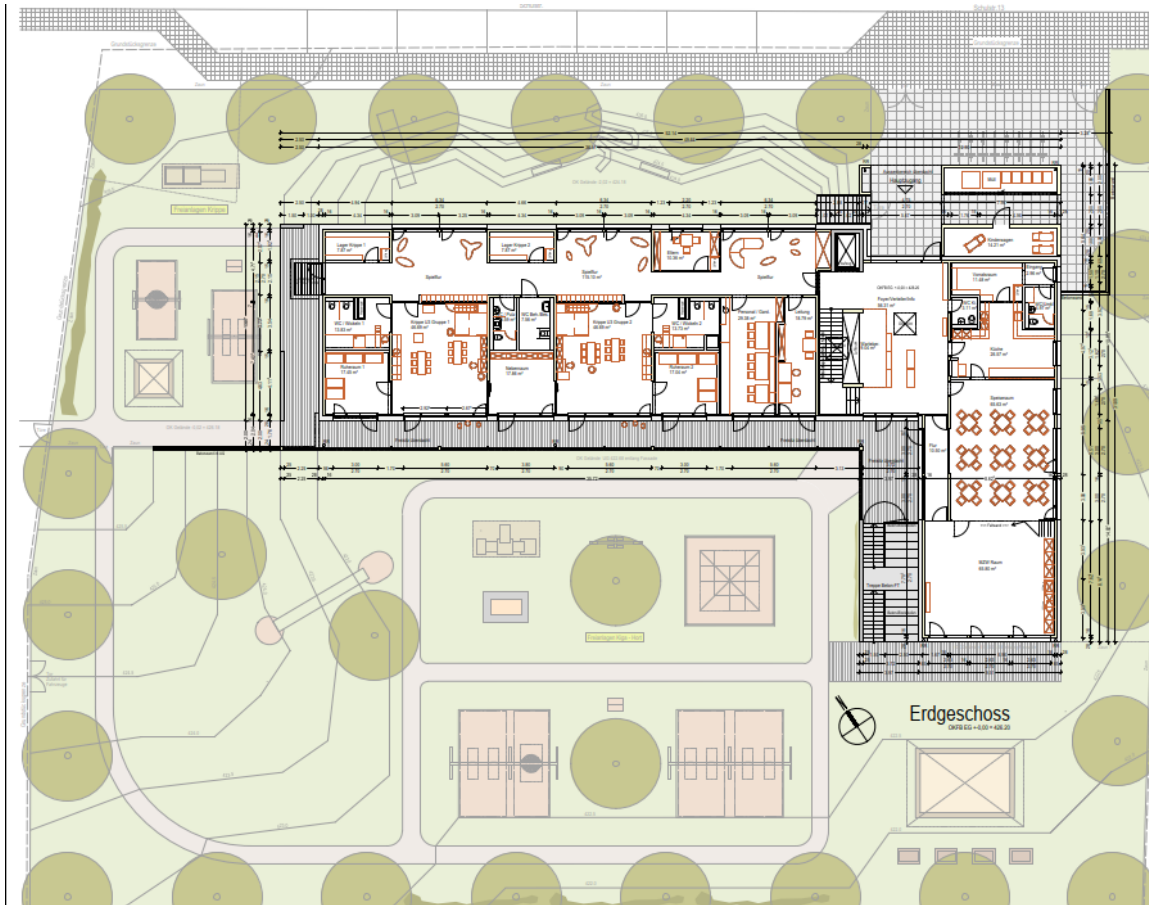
Grundriss geplante Kindertagesstätte (Quelle: SSP Planung GmbH)
